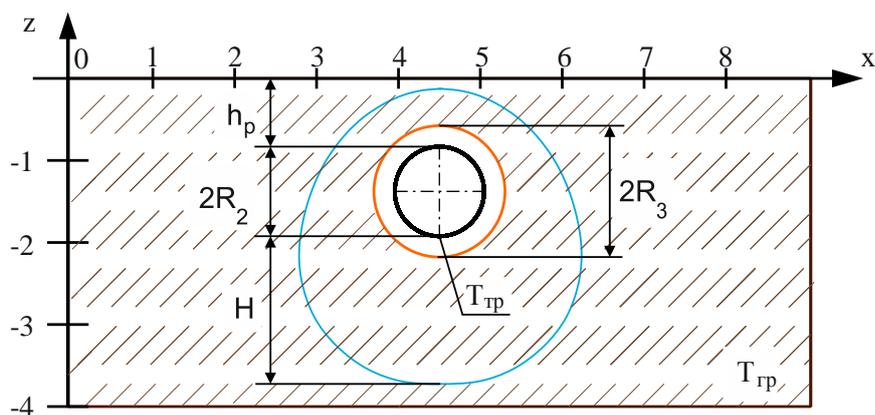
Схема к определению глубины протаивания грунта под трубопроводом:
